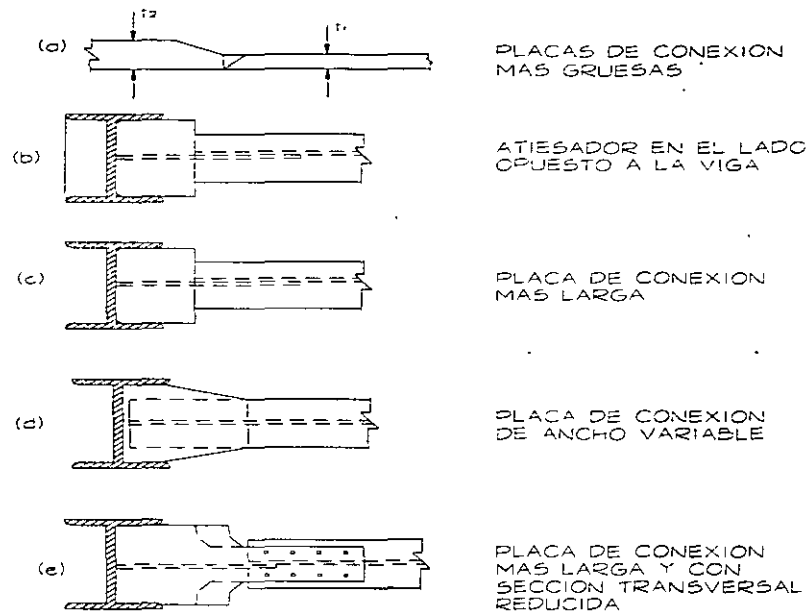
Medidas para mejorar el comportamiento de juntas con Vigas unidas al alma de la columna
